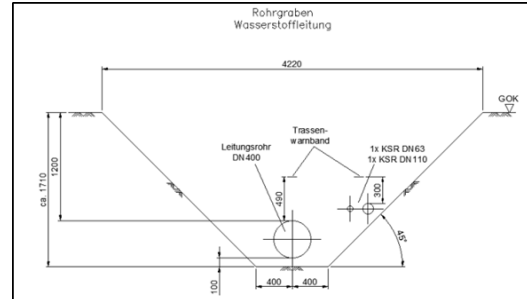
Standardgrabenprofil Wasserstoffleitung bei offener Bauweise
